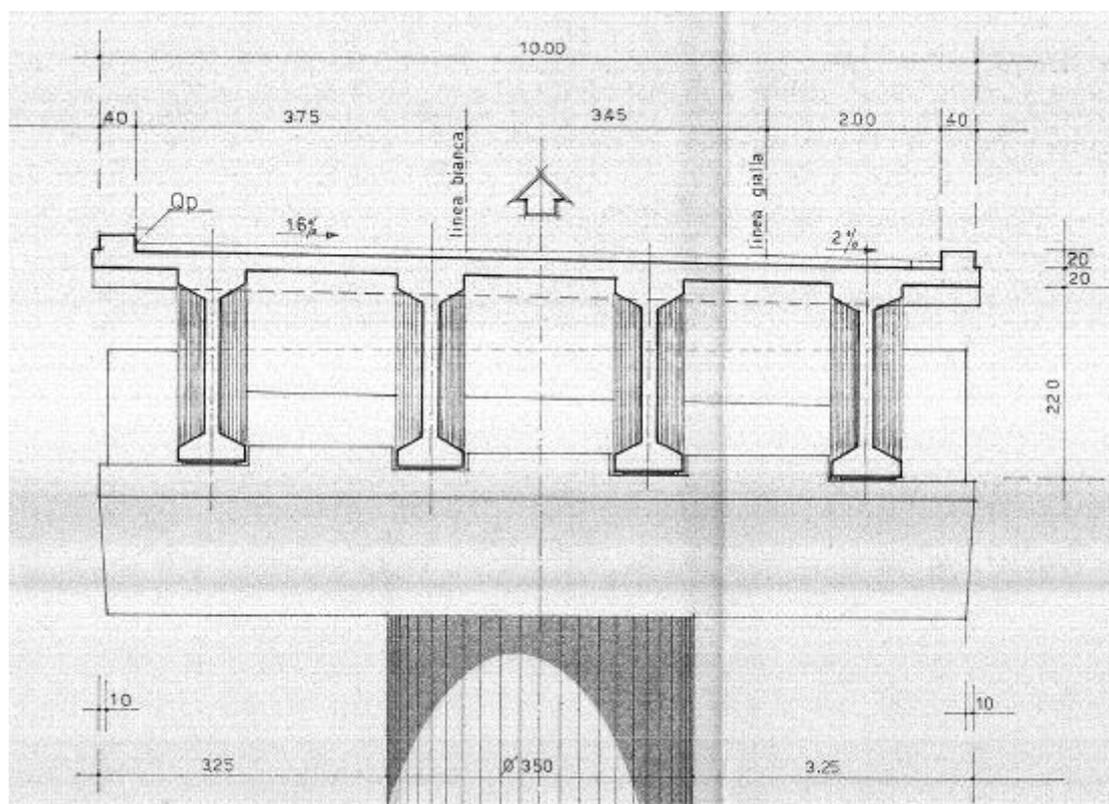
Impalcato a 4 travi in CAP – Sezione trasversale in rettilo
